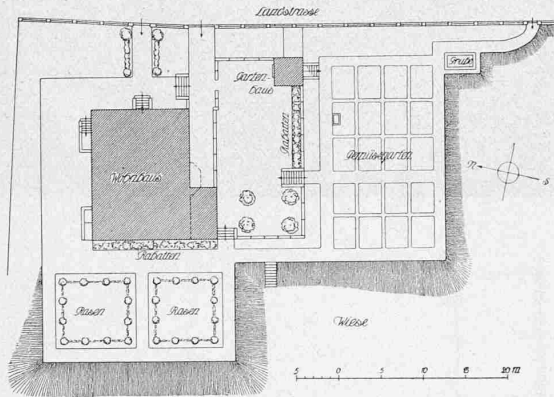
Haus «Blumenegg». — Lageplan 1 : 800.
